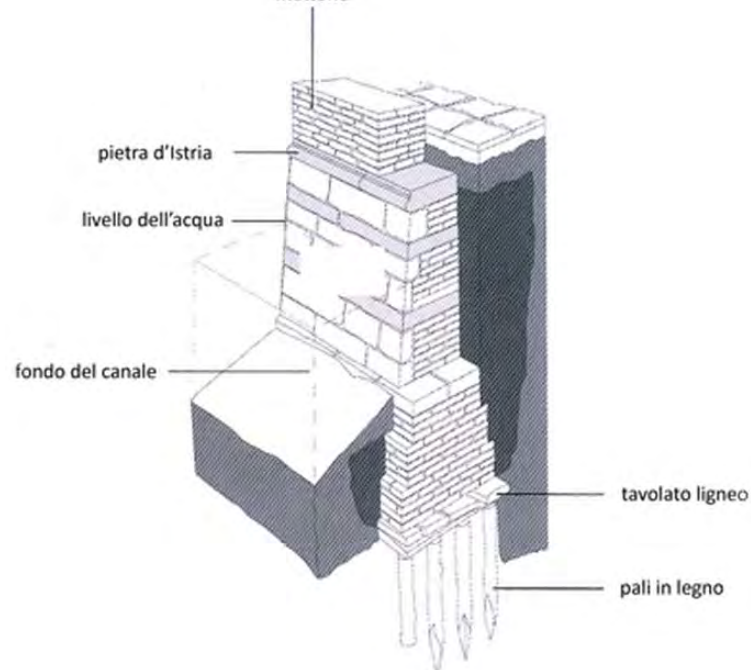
Schema fondazione tipica Veneziana (Corila)
